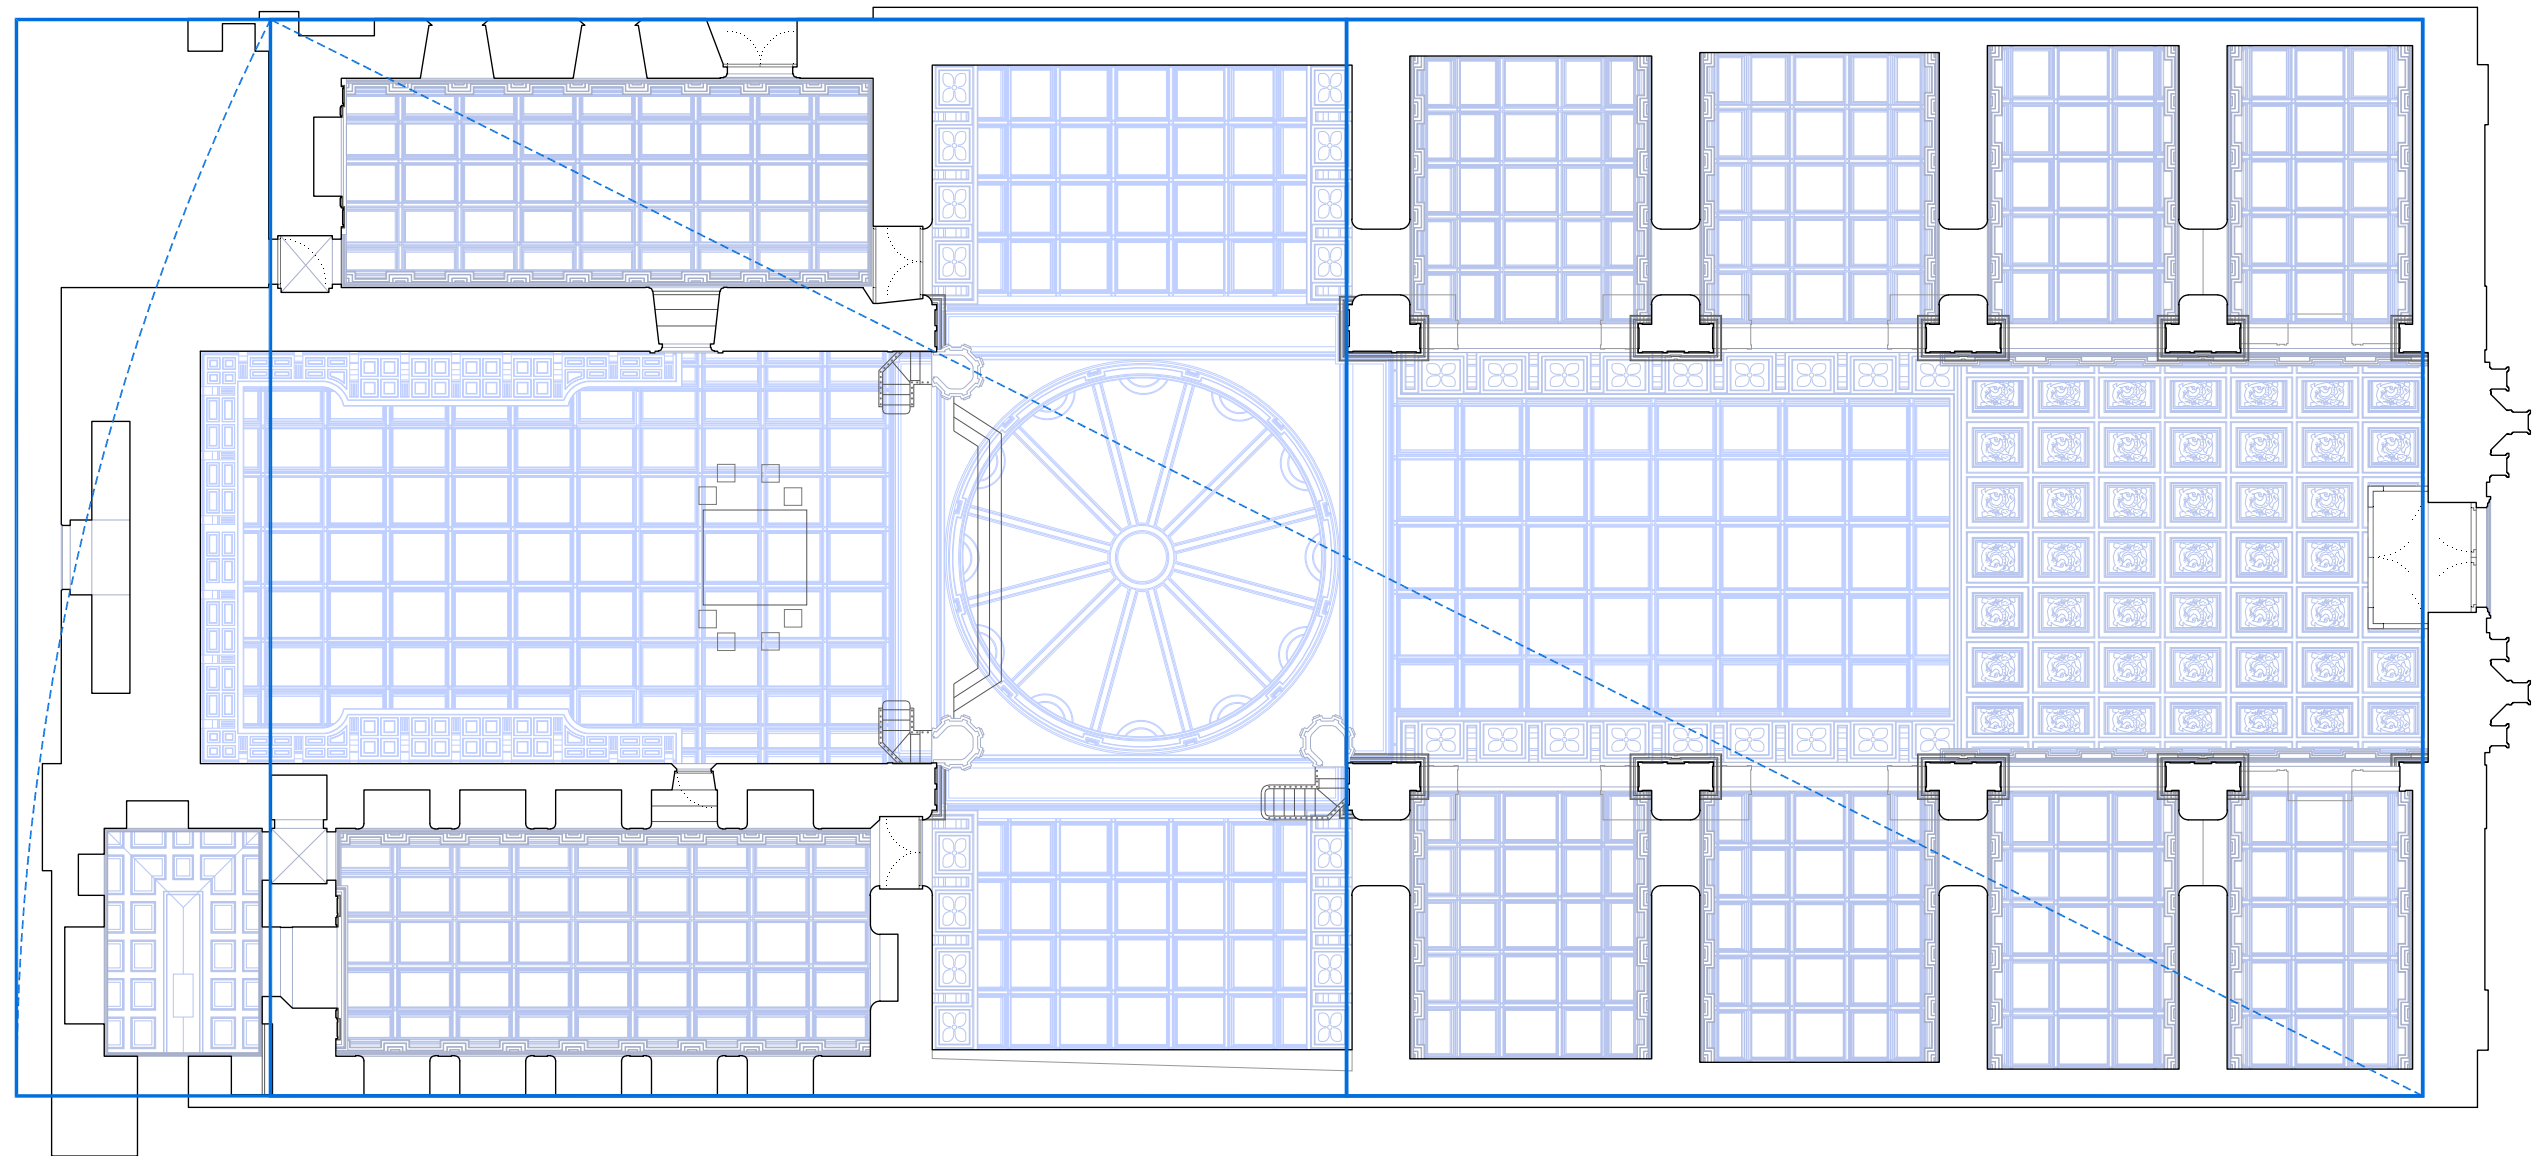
Construcción de un trazado geométrico para la planta de la iglesia de San Martín Pinario. Paso 2.
